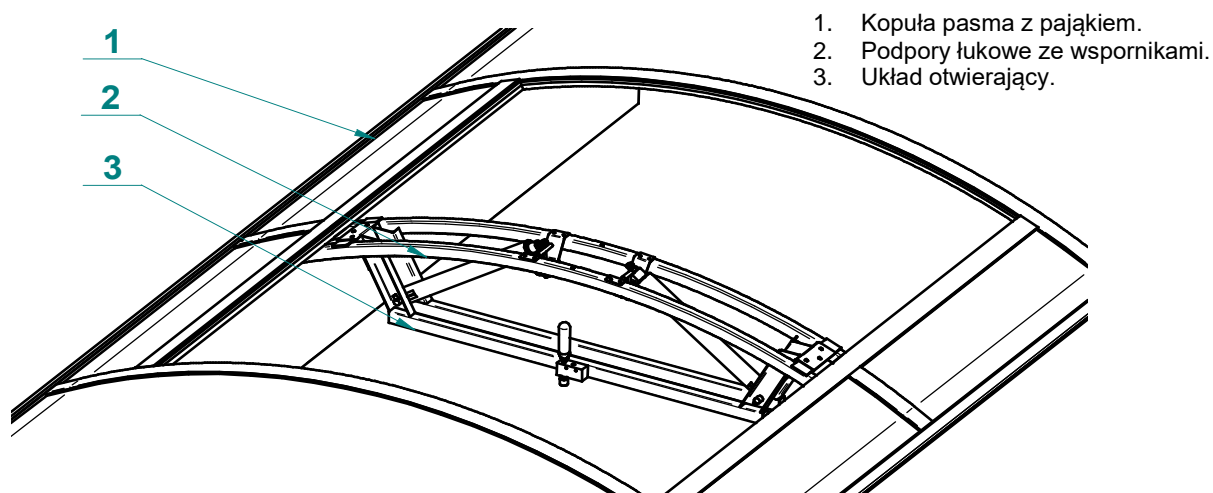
Przykładowe pasmo świetlne przygotowane do montażu klapy
